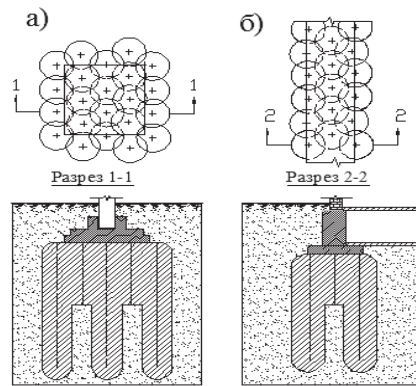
Схема комбинированного закрепление грунта под фундаментом колонны (а), несущей стены (б)
